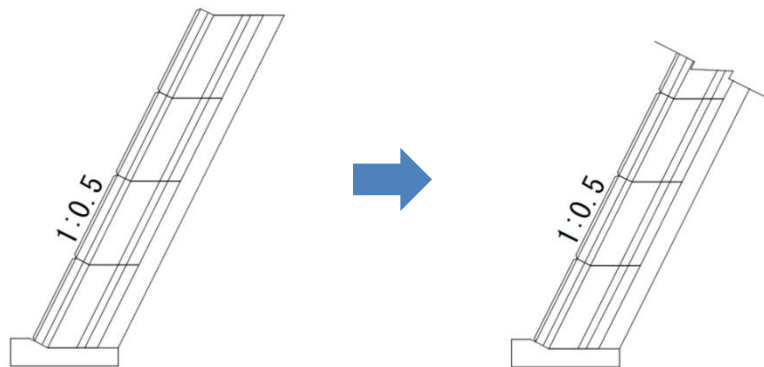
胴込めコンクリートの打継ぎ位置の作図に用いる断面図
